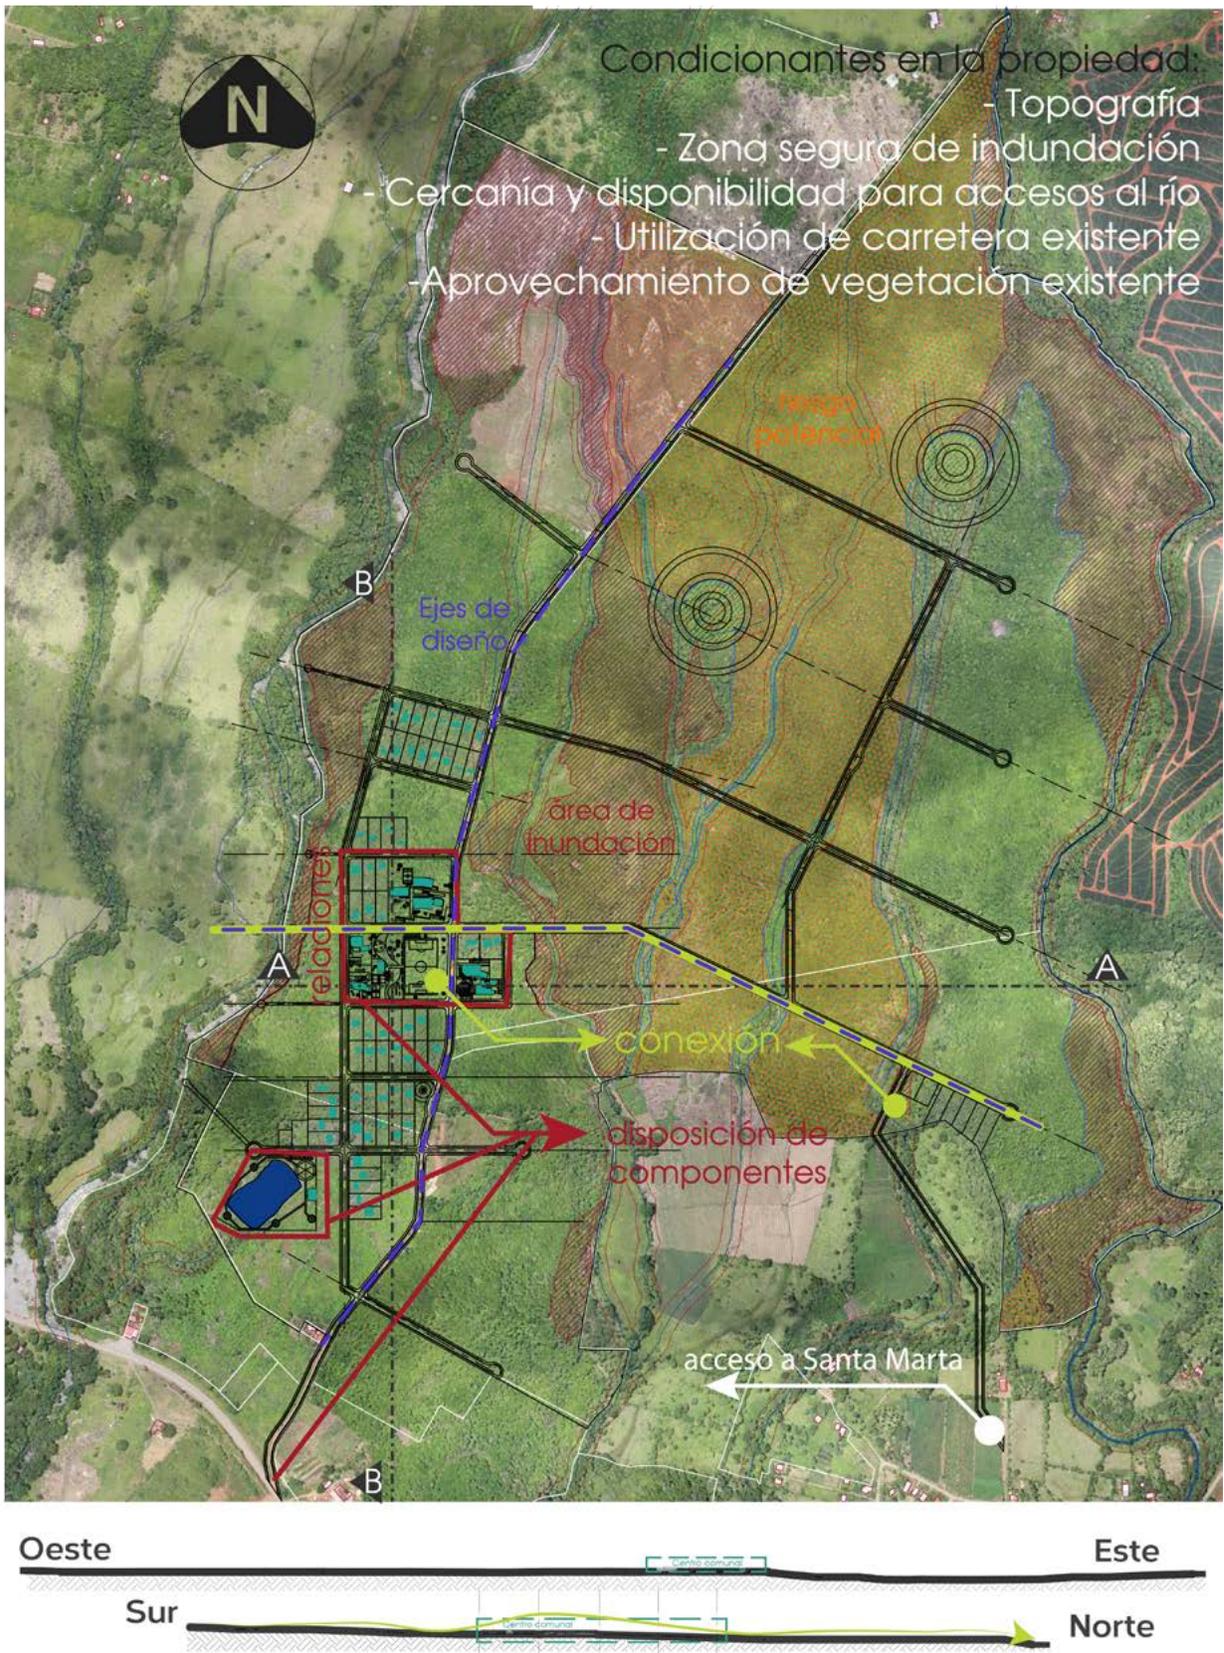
Planta con condicionantes de diseño de conjunto para Parcelas de Rancho Coco. Fuente: Elaboración propia.
